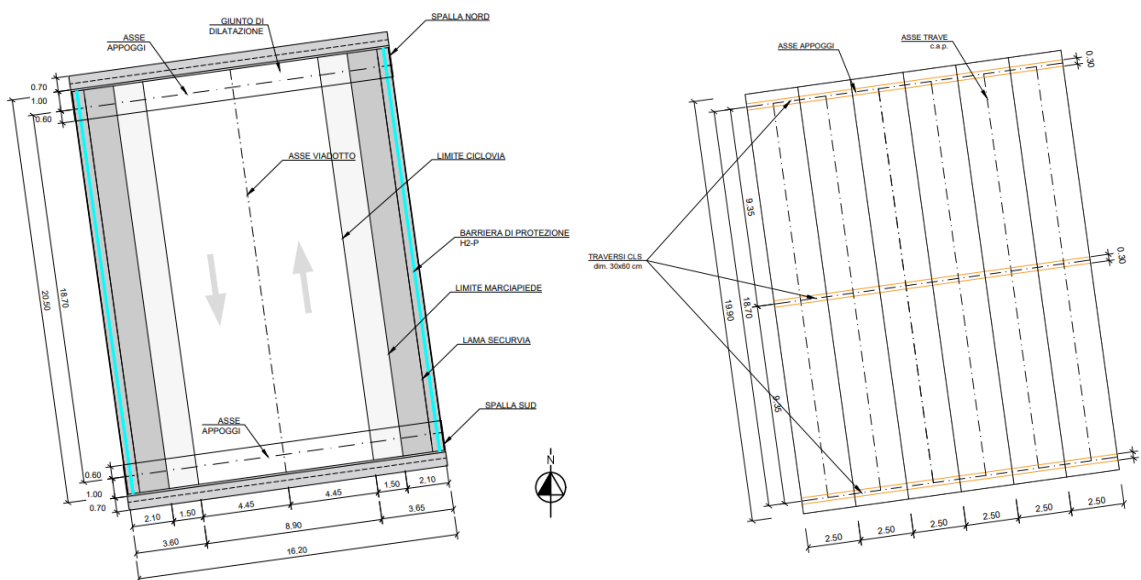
Pianta dell'impalcato del nuovo ponte
